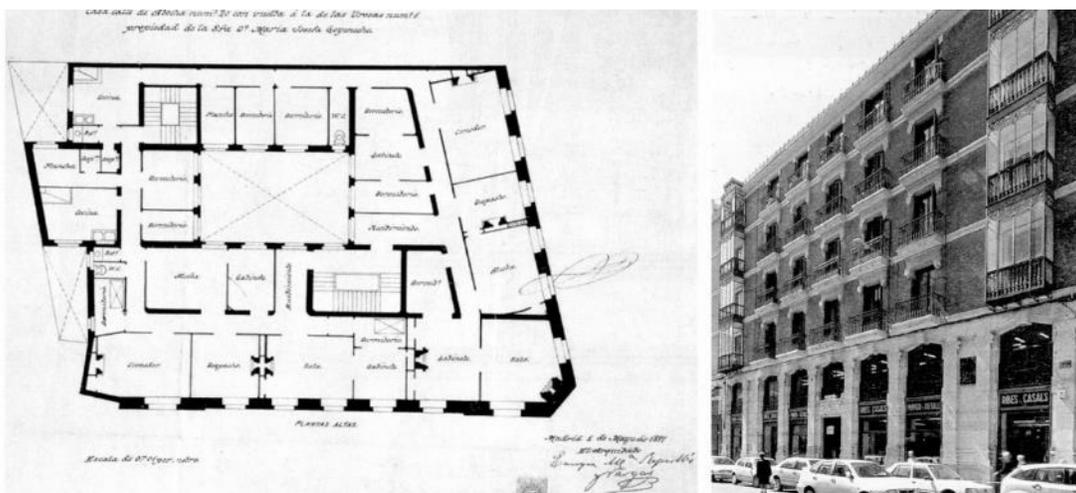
Planta y fachada de un edificio arquetípico de apartamentos Madrileño de finales del siglo XIX del arquitecto Enrique María Repullés y Vargas
